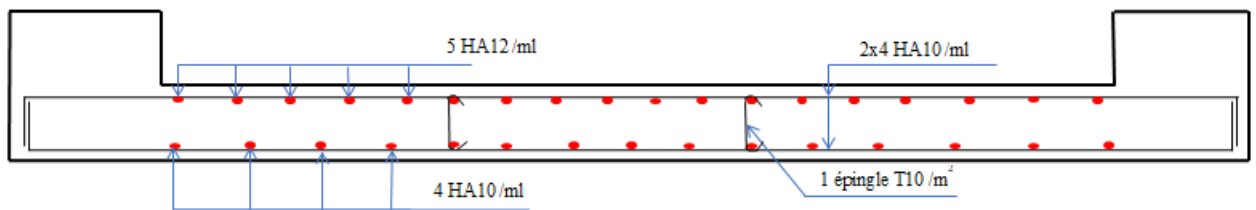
Schéma de ferrailage des mur de soutènement
